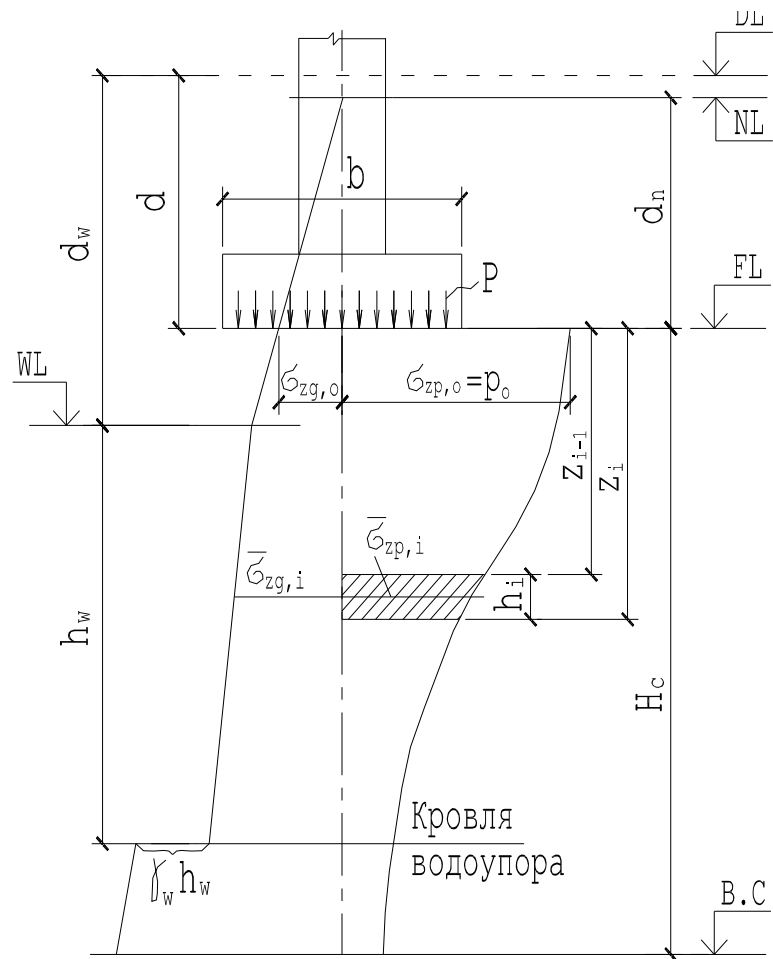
Схема распределения по глубине напряжений от собственного веса грунта и дополнительных напряжений.
